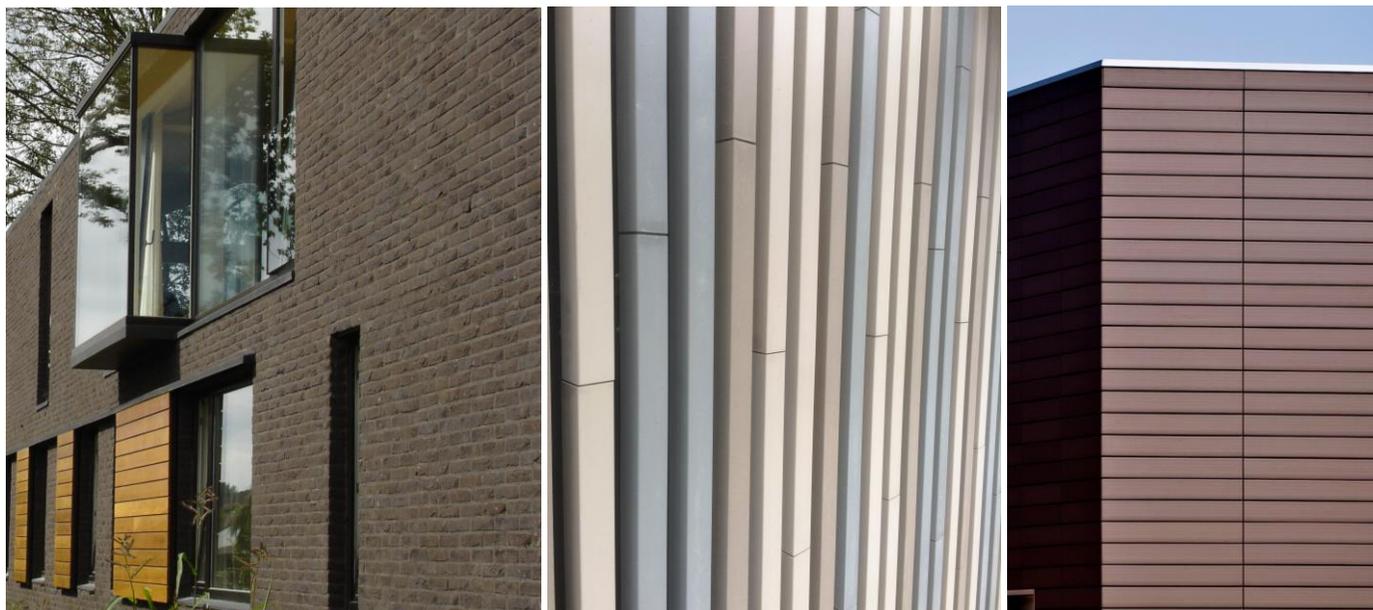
exemples de façades en terre cuite et en brique
